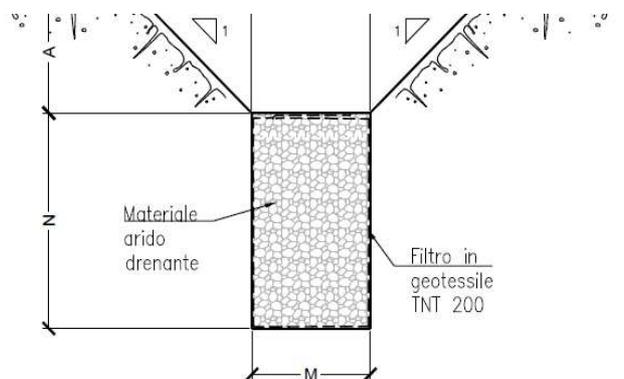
Fossi di Guardia – Sezione Tipo Disperdente
